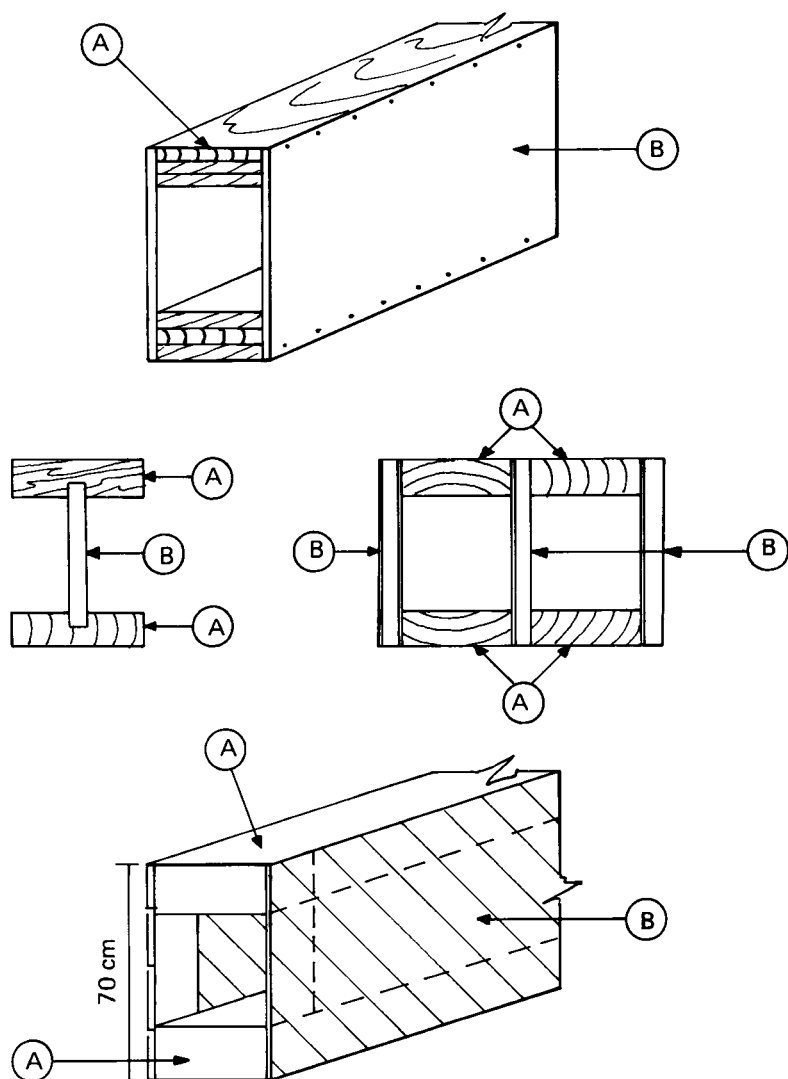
Vigas cajón y H que muestran la disposición de los elementos estructurales.
